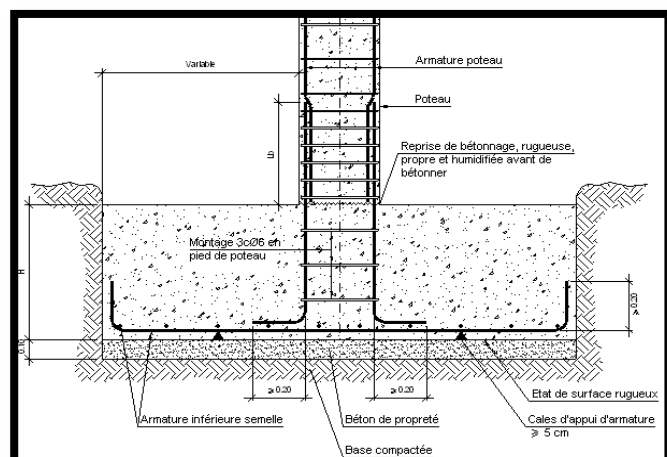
coupe au niveau d'une fondation ponctuelle<sup>91</sup>
